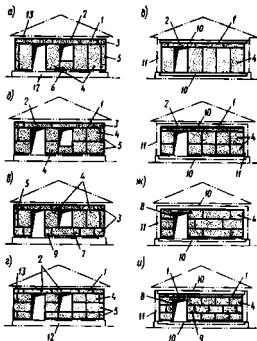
Схемы разрезы стен одноэтажных жилых зданий на крупные блоки:
